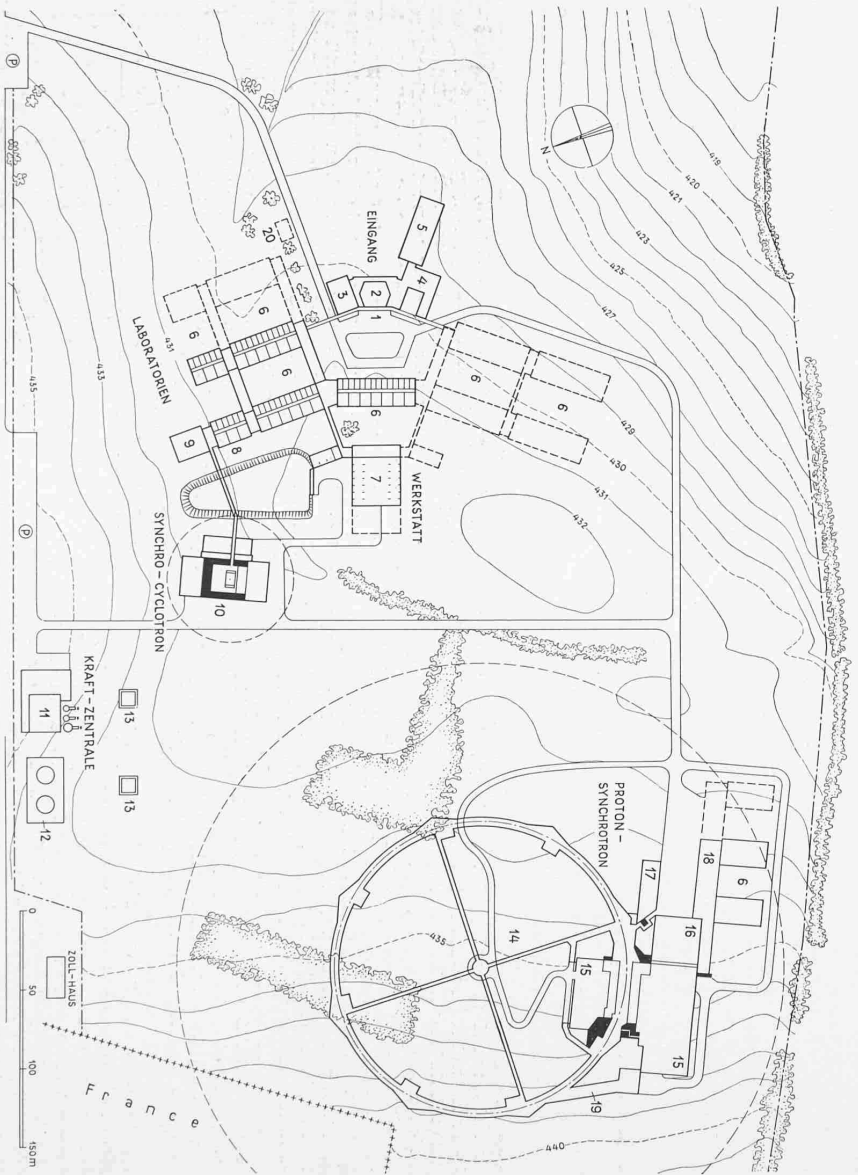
CERN-Laboratorien, Lageplan 1:4000
